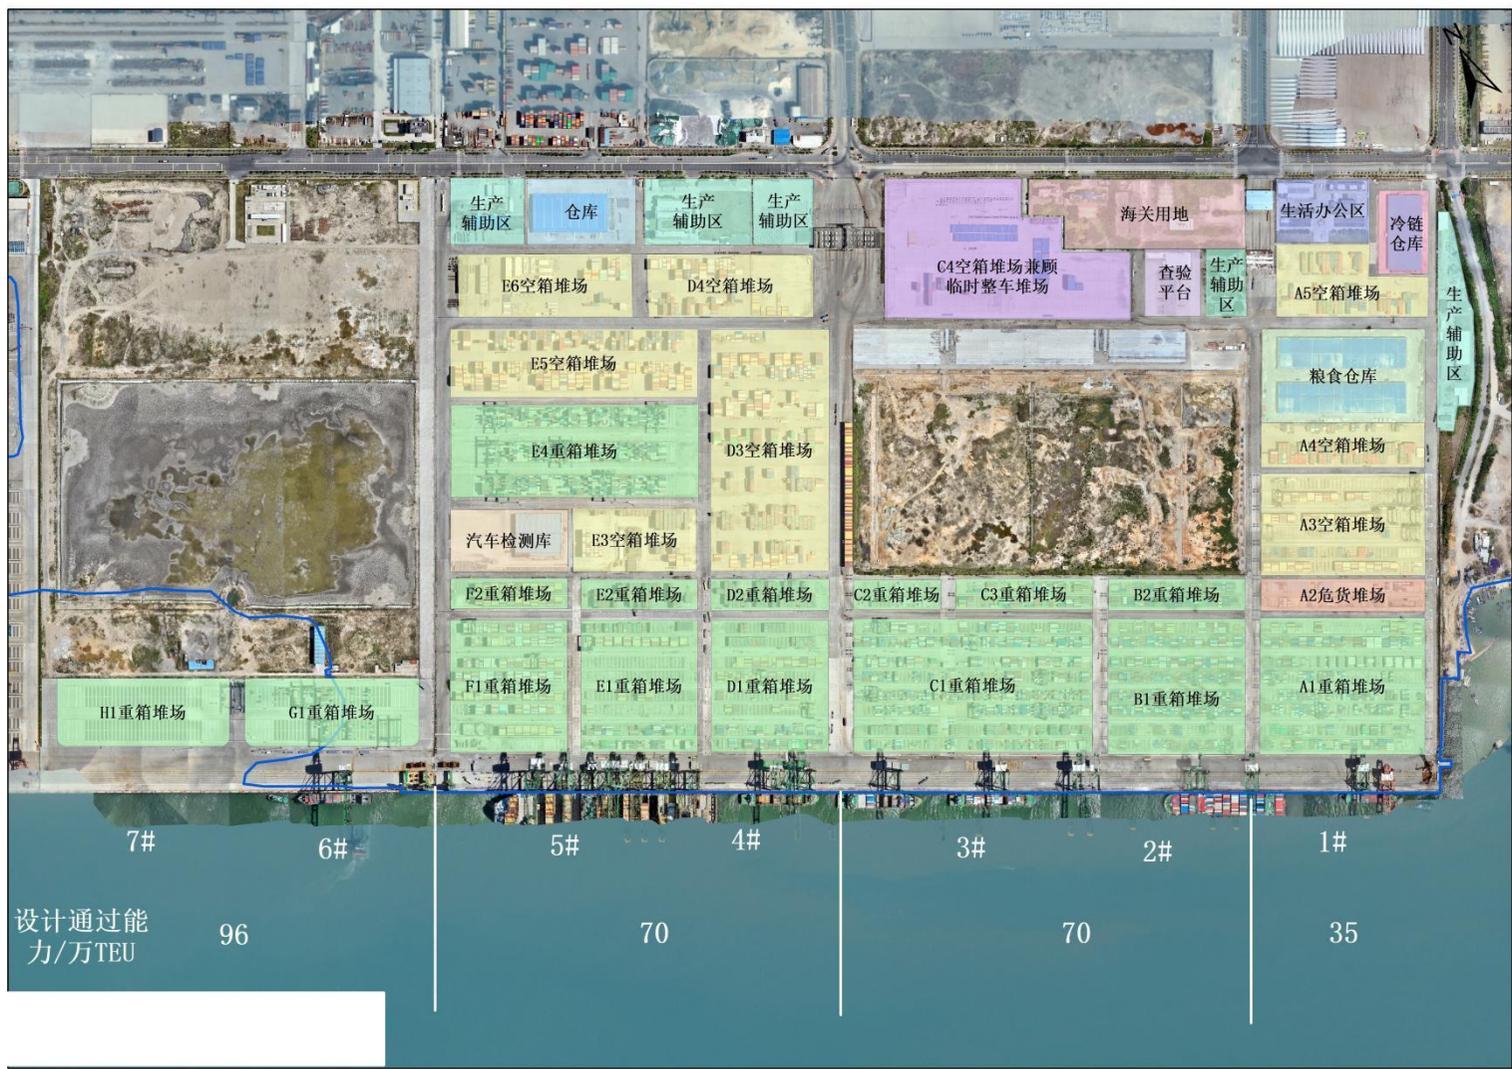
江阴港 1-7#泊位现状平面布置图
